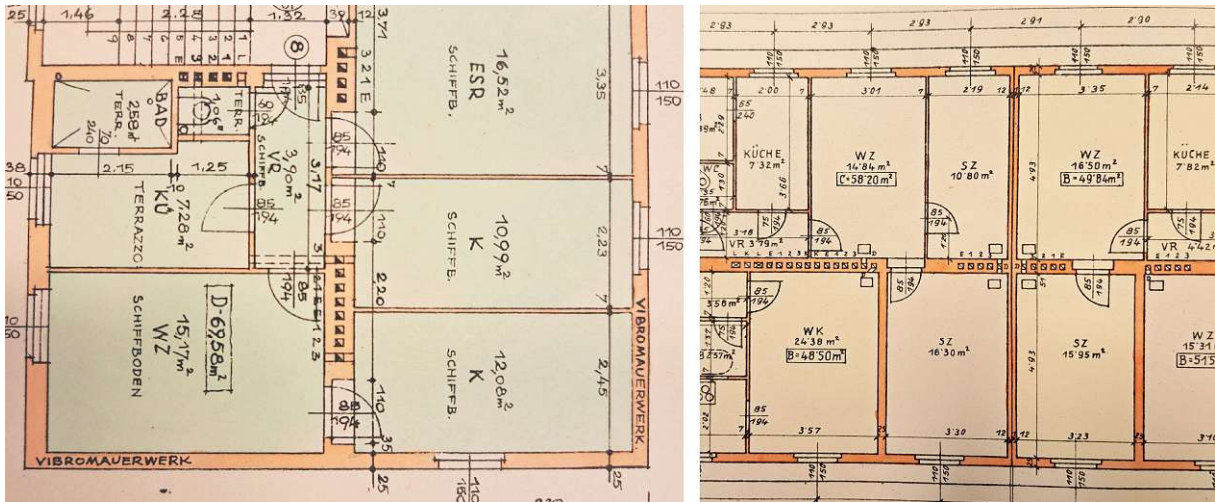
Planausschnitte Edgar-Schranz-Hof: Grundriss Auswechslungsplan 3. OG mit Außenwänden aus Vibrosteinen (links), Grundriss Einreichplan Dachgeschoss ohne Angabe der Mauerwerksart (rechts) [56]
